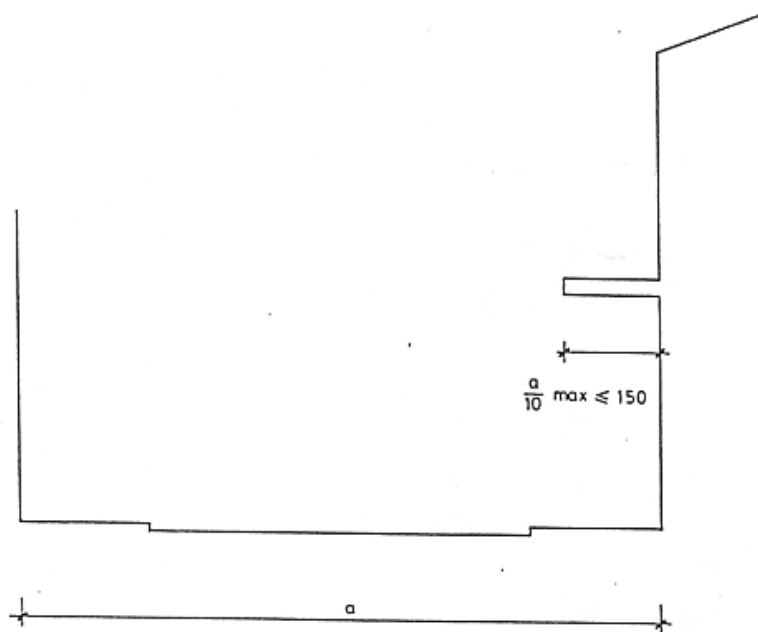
Reculada de la darrera planta (art. 15.1.2)
